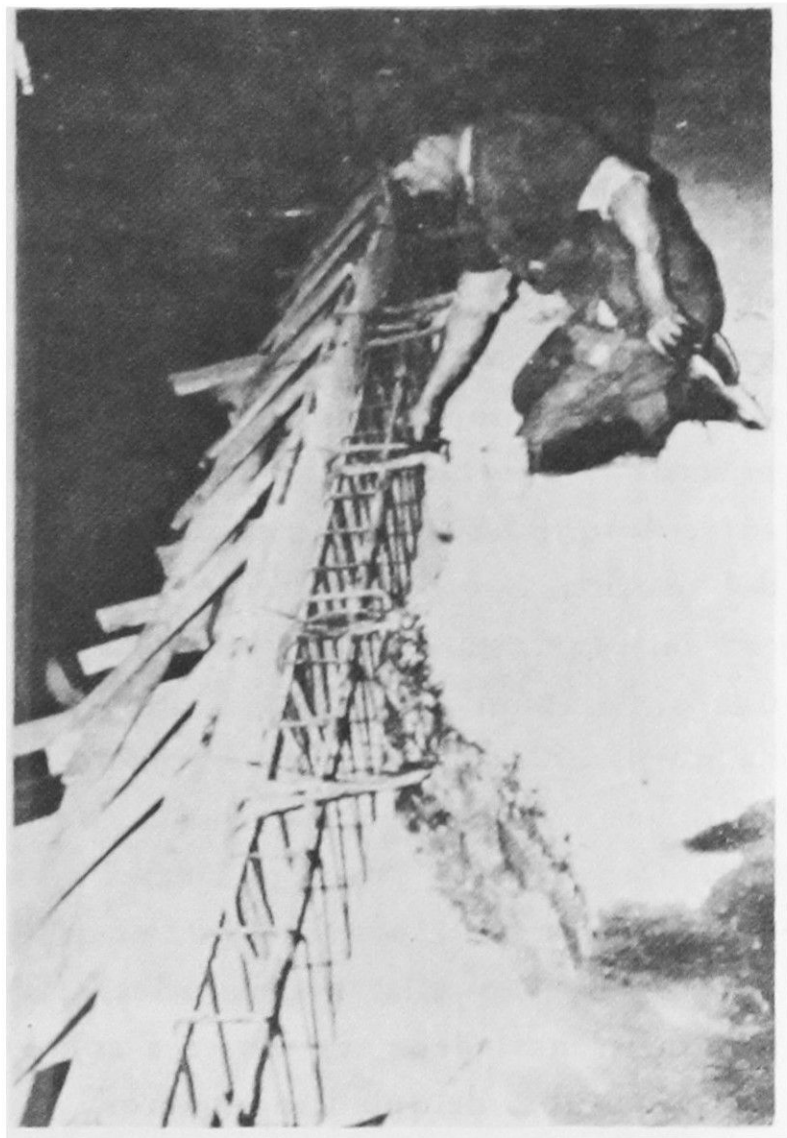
Viga de borde unida a una placa de hormigón mediante resinas epoxi.
